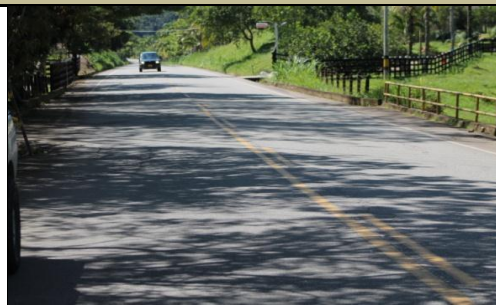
PLACA IDENTIFICACION PUENTE (NO EXISTE).
